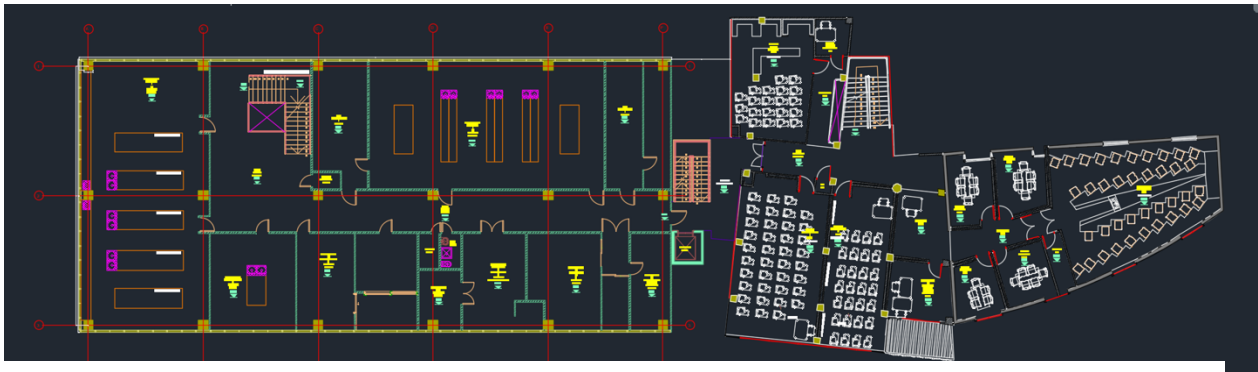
"Planimetría Nivel 3 Facultad Farmacia de la UV"
